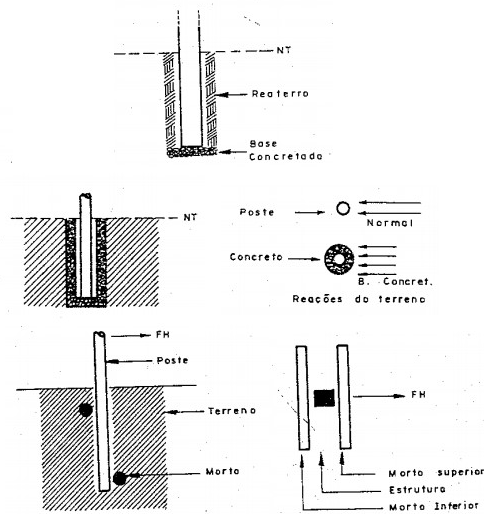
Fundações em Postes com Concreto no Fundo (acima), Concretagem da Base (meio) e Utilização de Mortos (abaixo). Fonte: [2]
